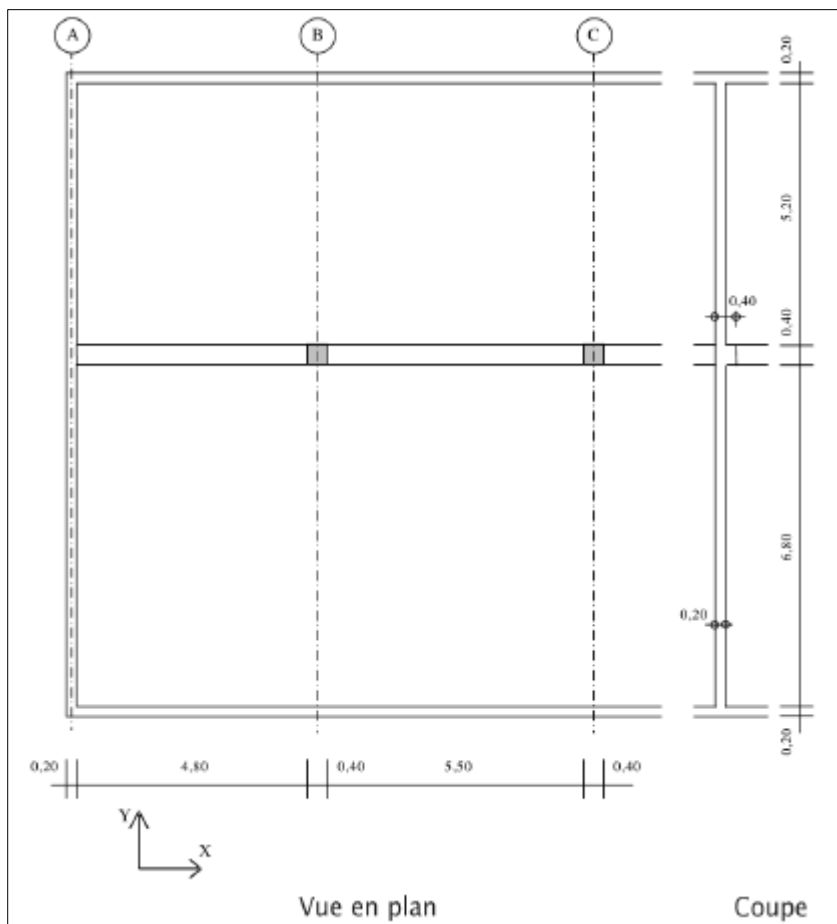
Vues plan et coupe (extrait du livre "Aide-mémoire ouvrage BA")
